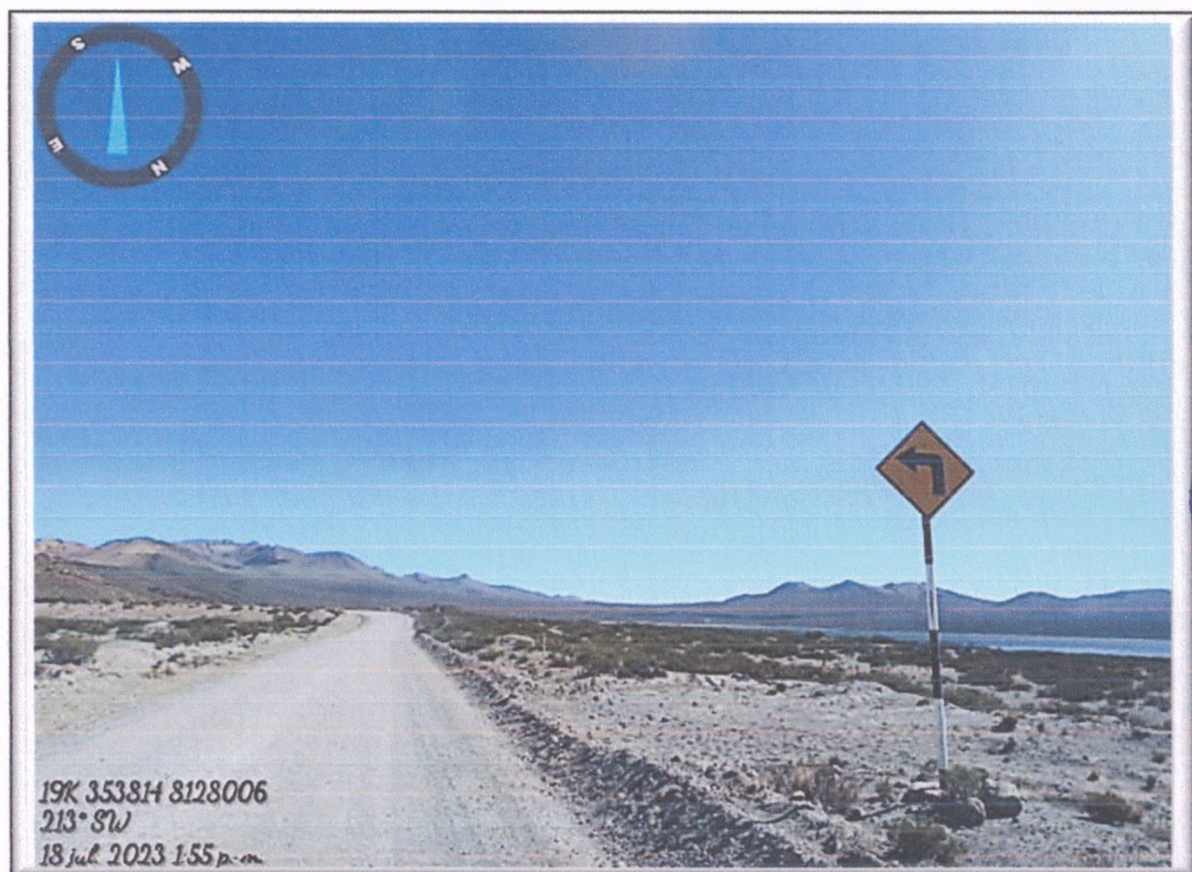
Vista de señal preventiva y cuneta saturada de piedras y arena M.D.
